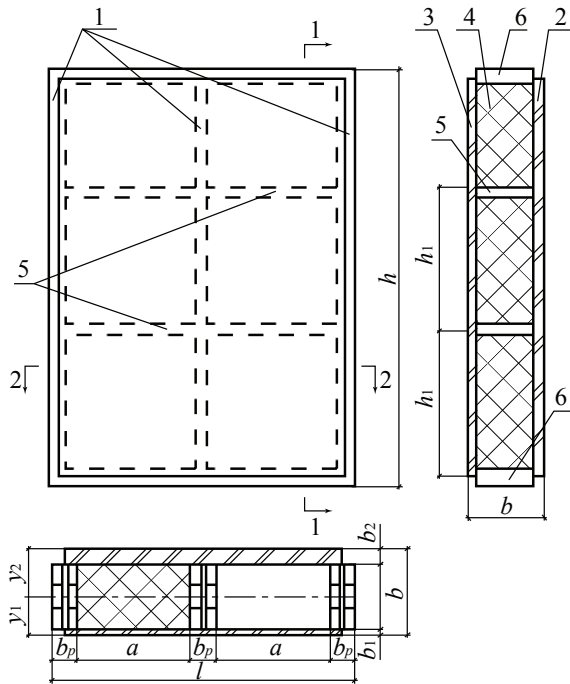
Общий вид и поперечное сечение стеновой панели с каркасом из комбинированных балок и обшивками из древесных плит: 1 – продольные стойки каркаса из комбинированных балок, 2 – наружная обшивка из древесных плит, 3 – внутренняя обшивка из древесных плит, 4 – утеплитель, 5 – ребра жесткости, 6 – обвязка (нижняя и верхняя)
